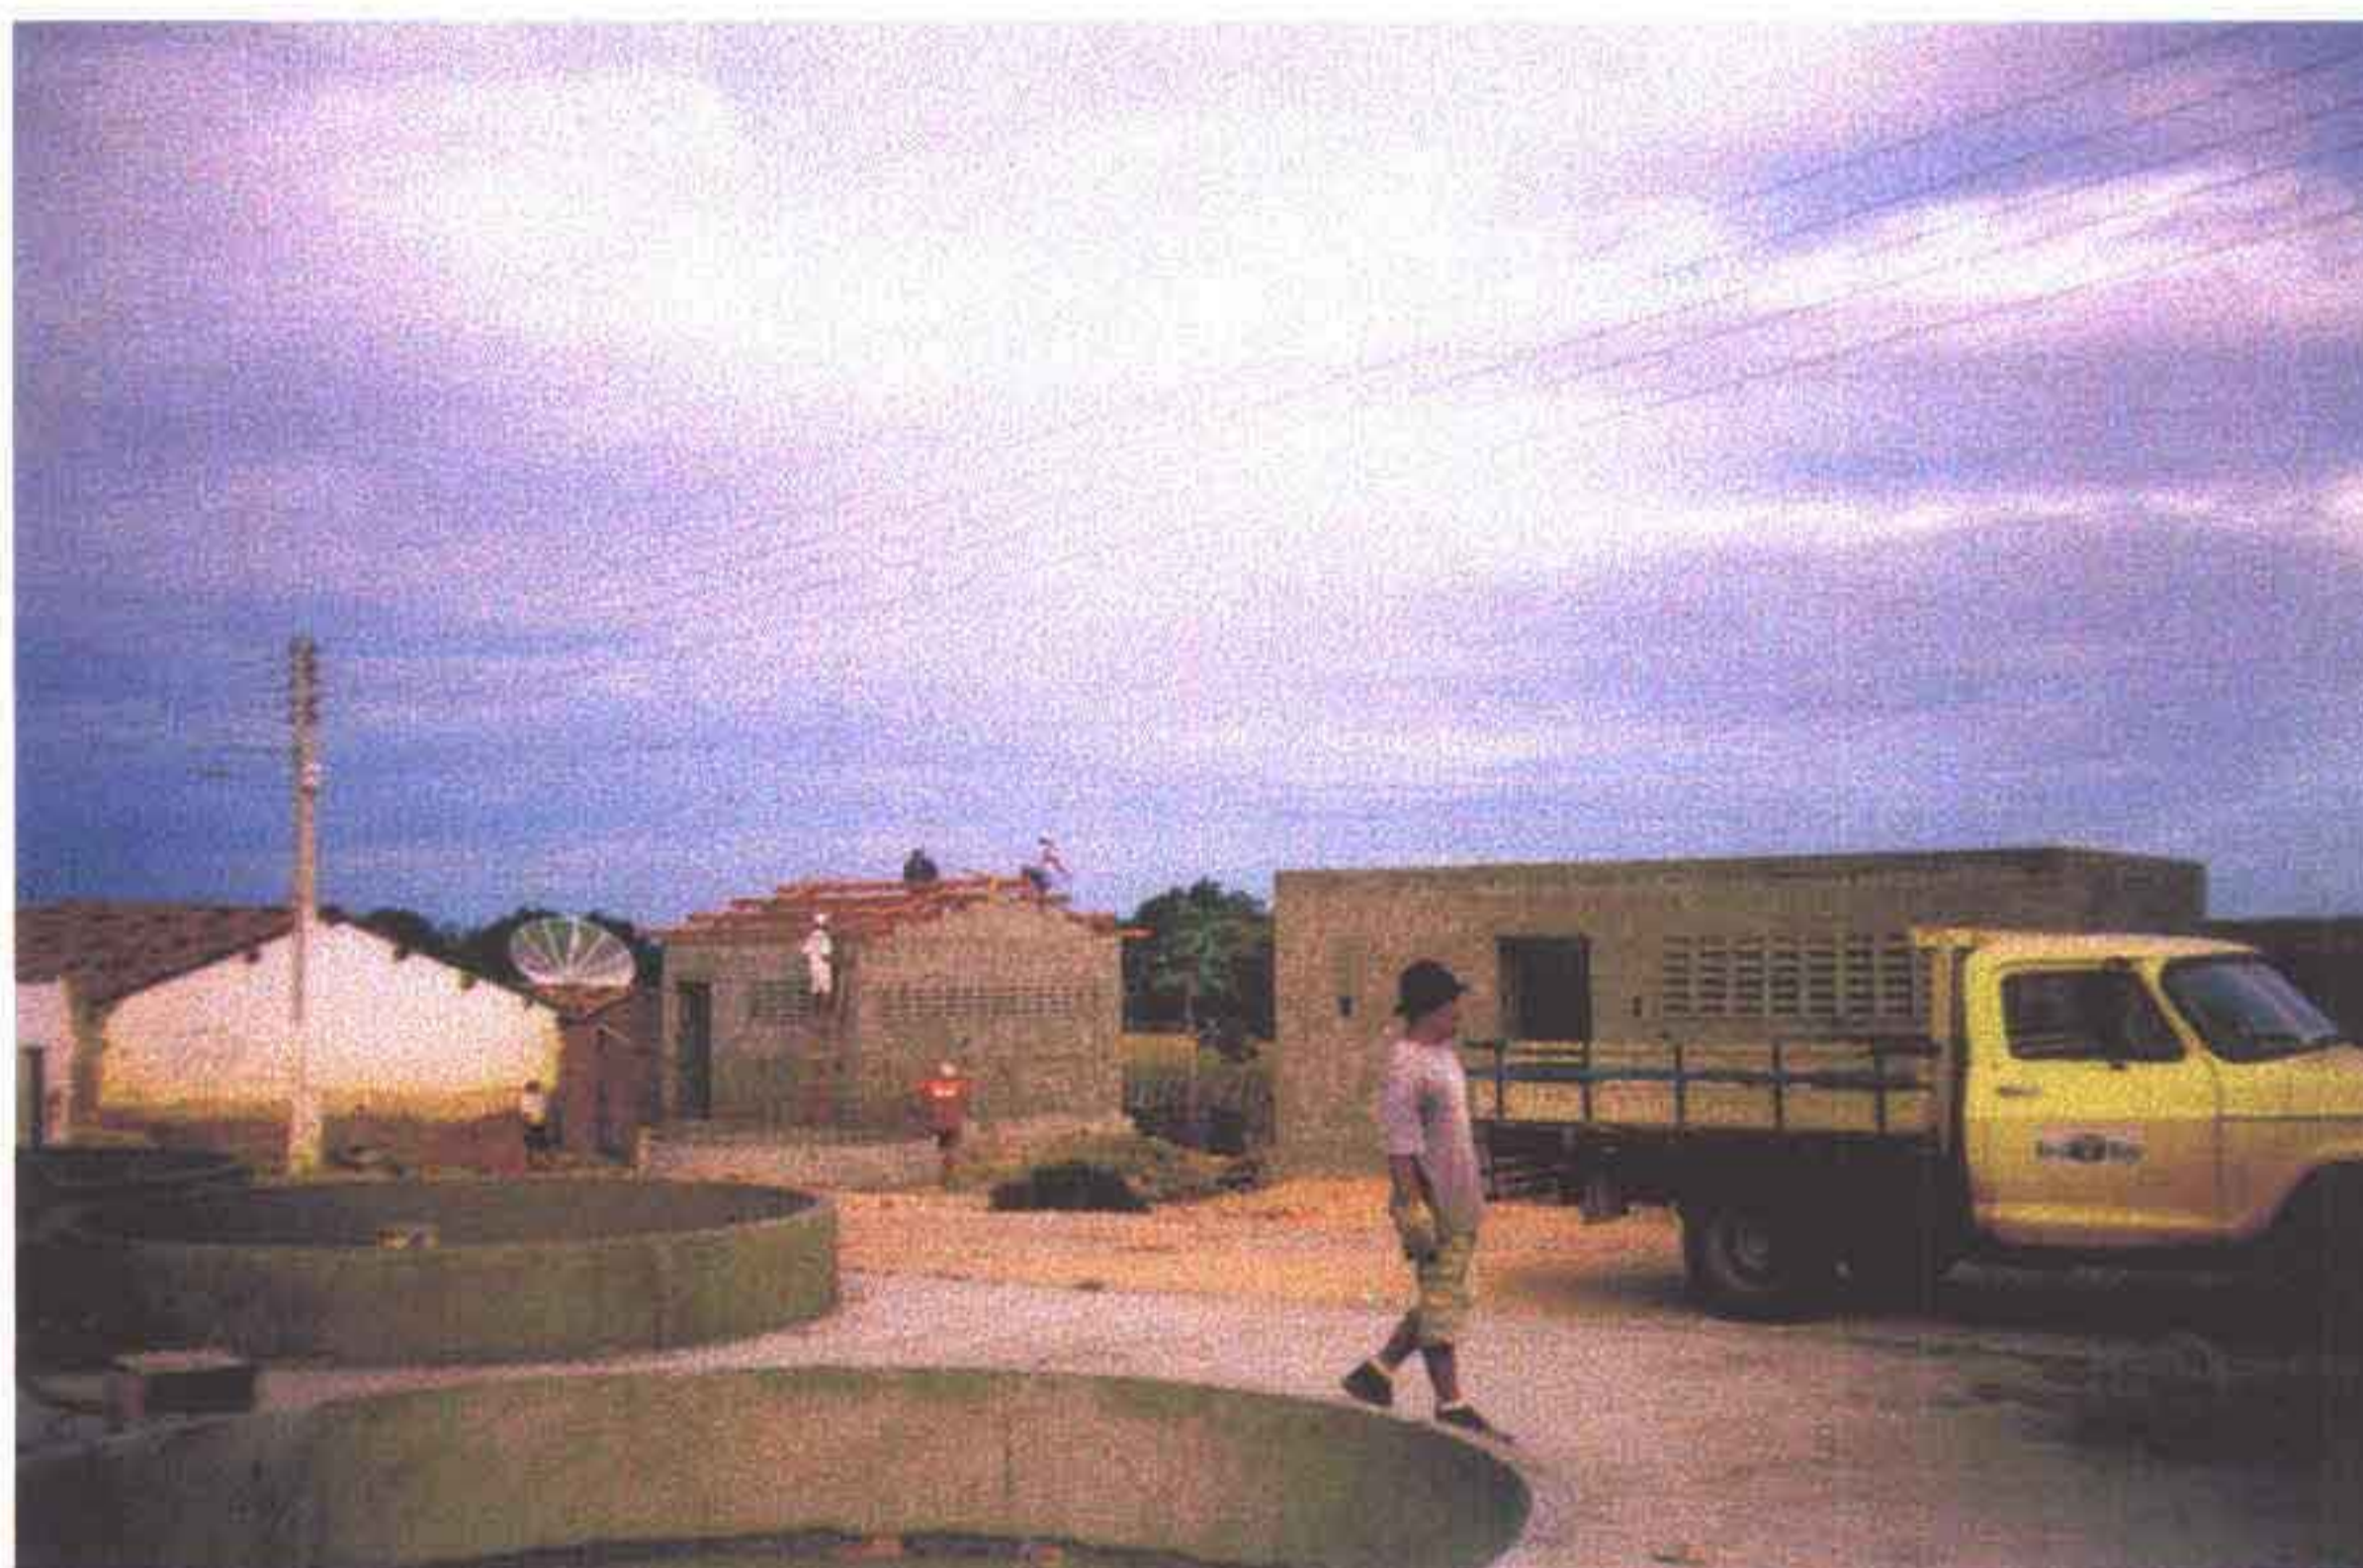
Início da construção da estação de tratamento d'água (ETA) Casa de Química e Estação Elevatória EE-1.
